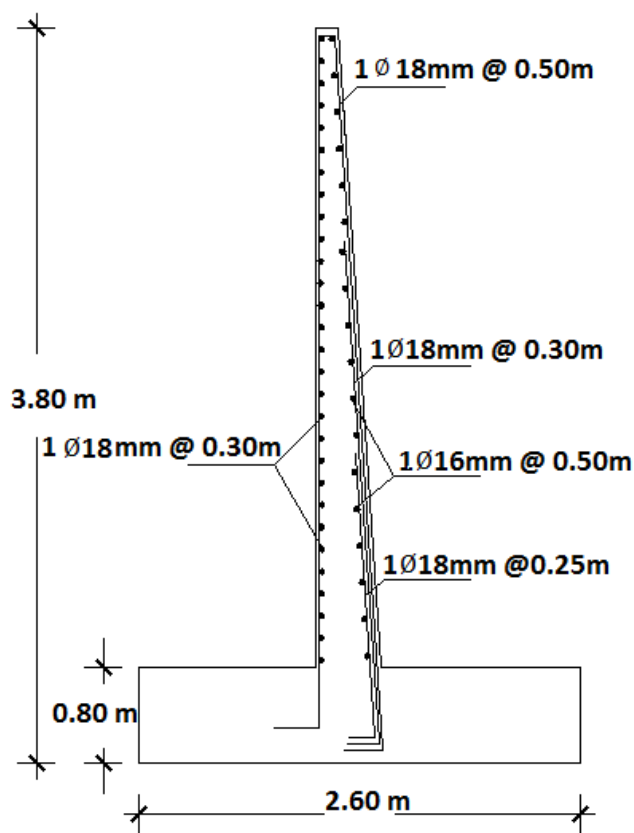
Detalle de la pantalla del muro de ala. Elaborado por: Autor
